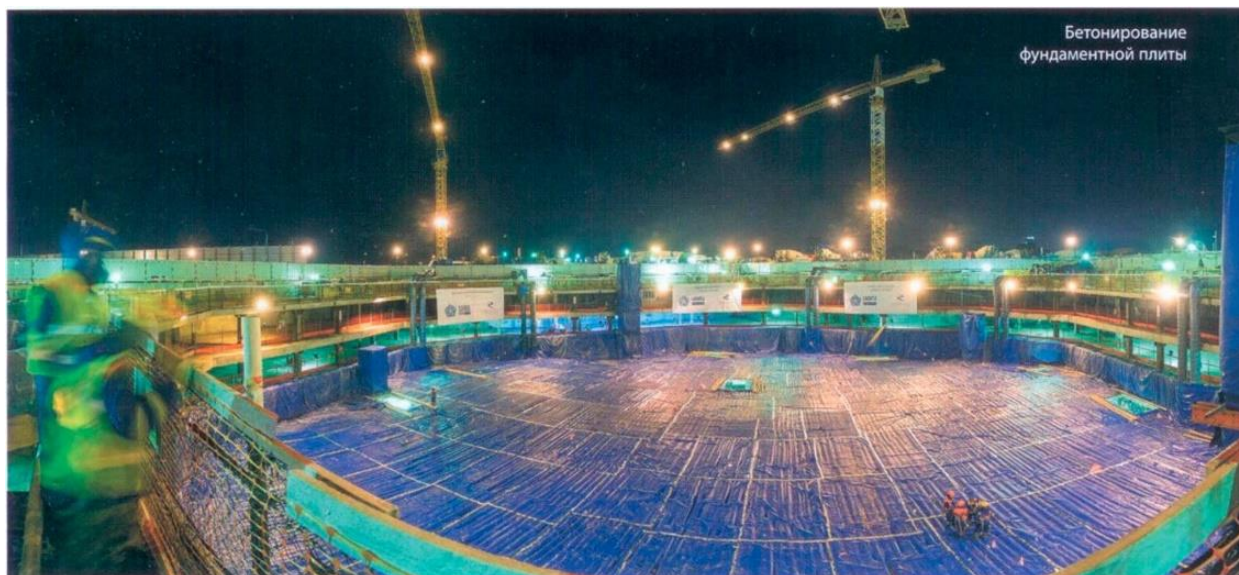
Бетонирование фундаментной плиты коробчатого фундамента
